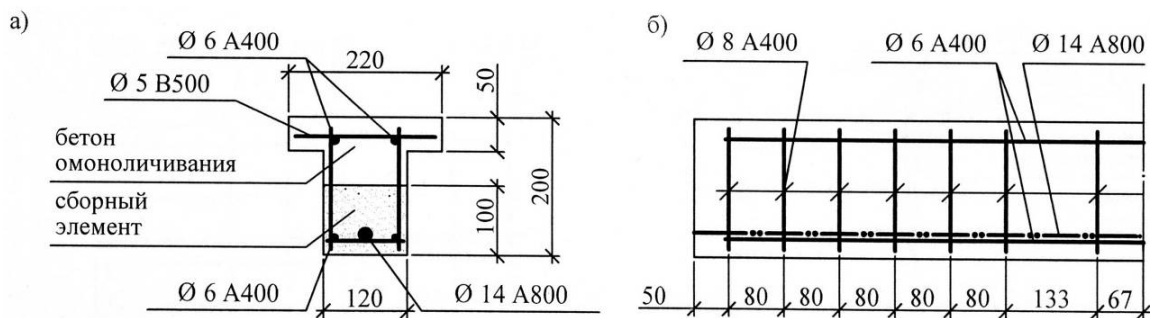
Конструкция и схема армирования опытных образцов: поперечное сечение (а); схема армирования (б)
